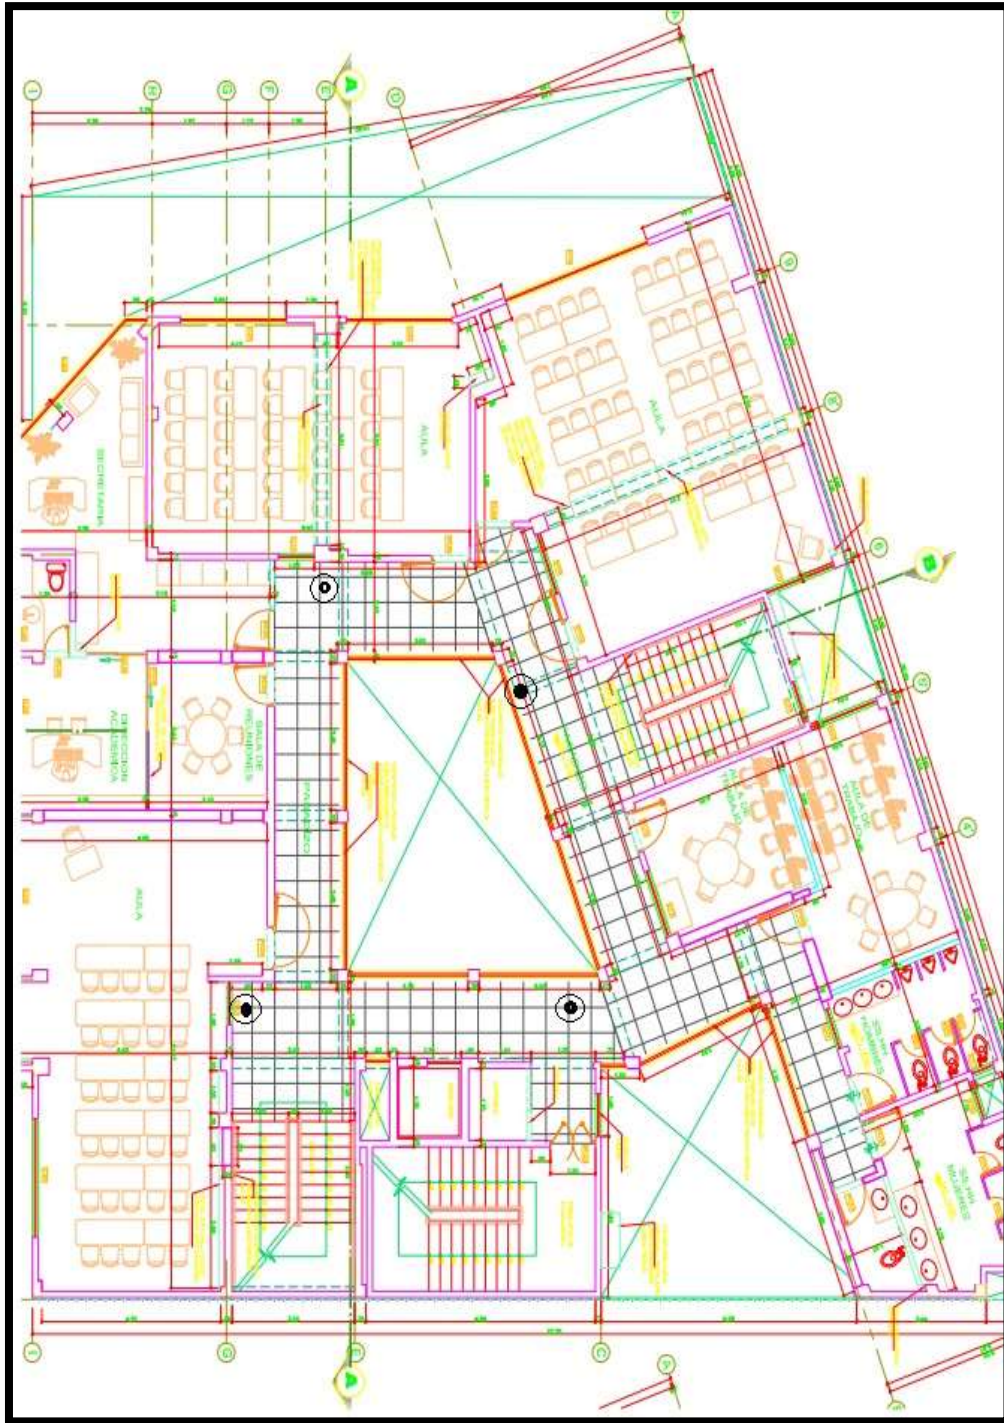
Plano de distribución de oficinas Piso 2 sede ENAP.
